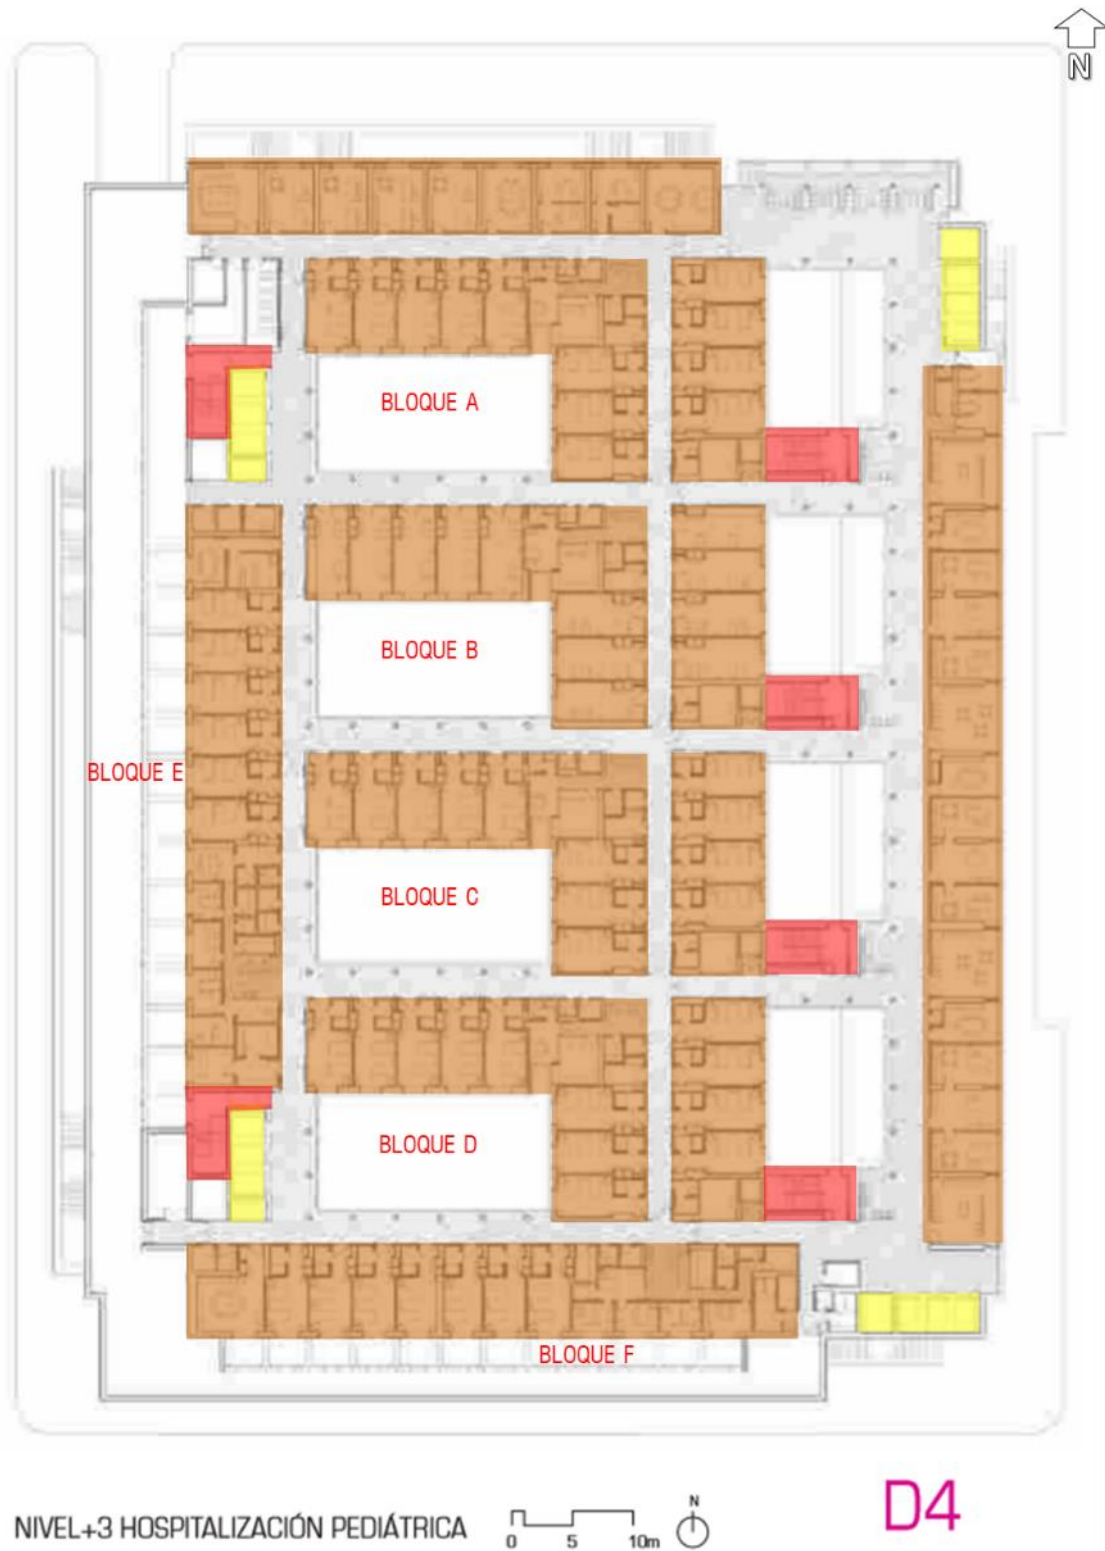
, Planta hospitalización pediátrica. Fuente: Construir sobre lo construido
